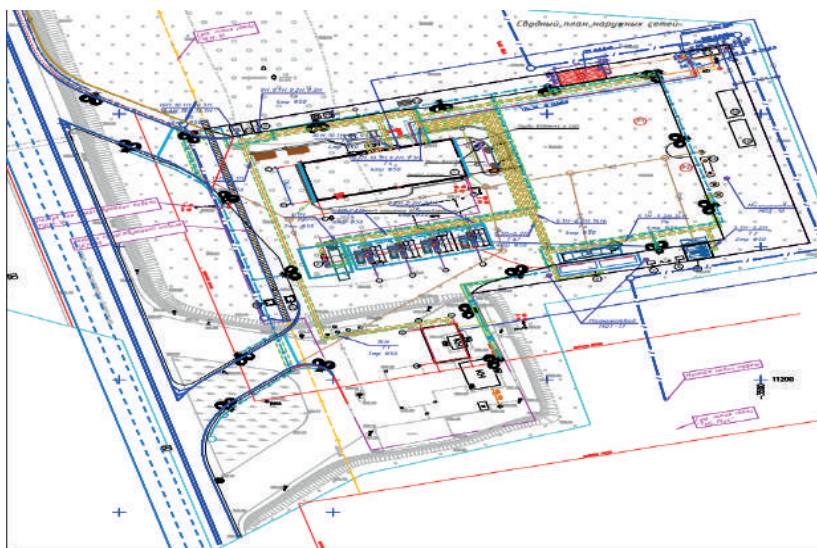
Сводный план наружных сетей при строительстве АЗС
